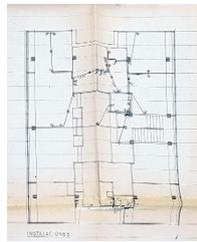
Planta Instalaciones B-3-3-E. 1964. Fuente: Archivo Municipal da Coruña
